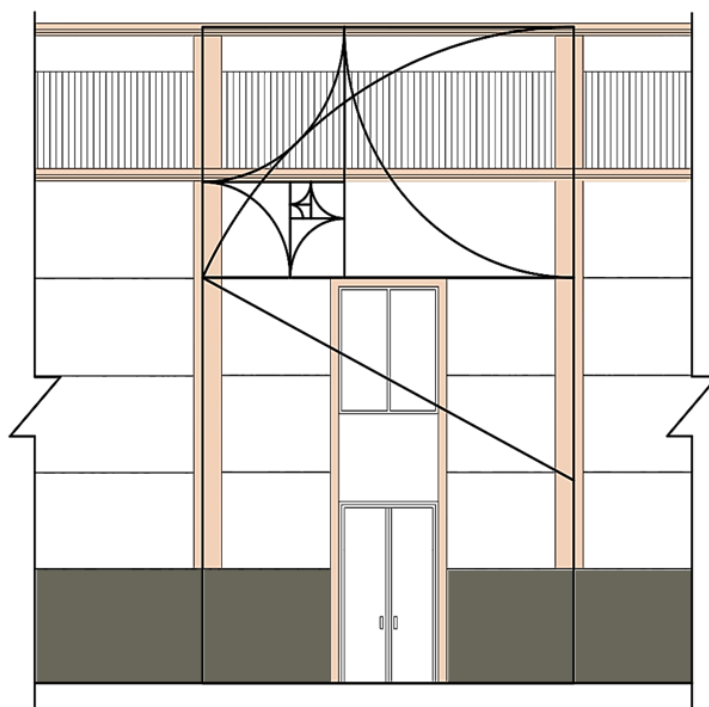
Propuesta fachada de híbrido. Fuente: Propia.
